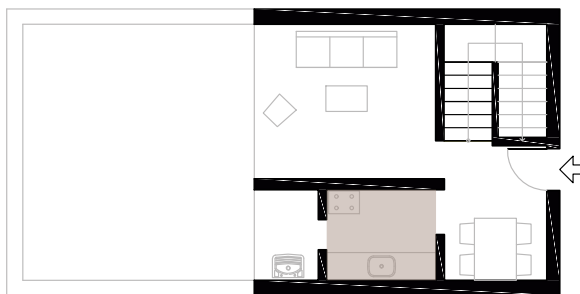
planta do 1º pavimento da unidade do Conjunto Residencial de Paquetá. Escala 1:100. Fonte: elaborado pela autora.
